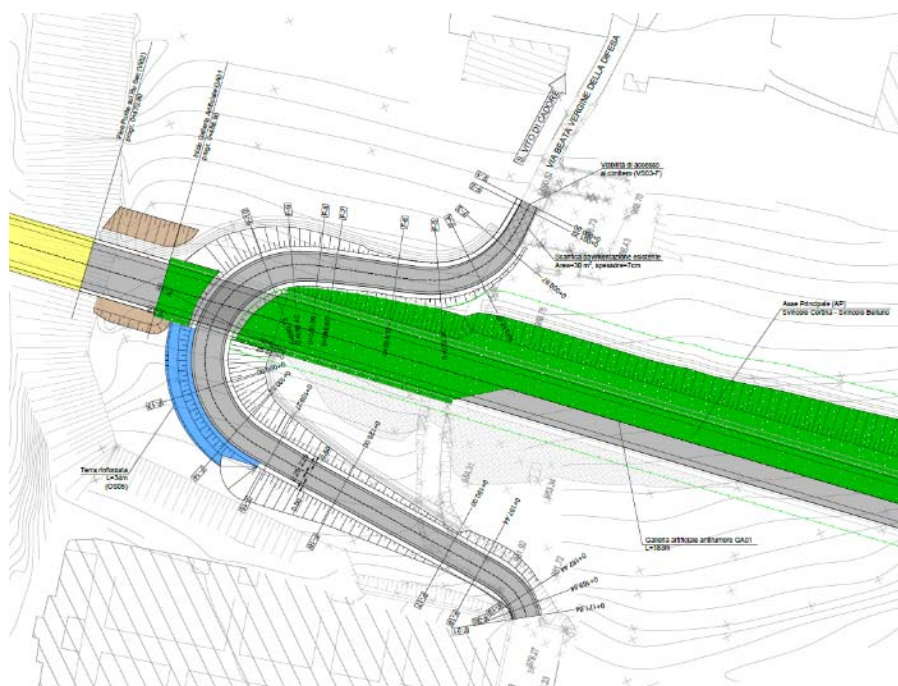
Stralcio Planimetrico – Via Cimitero
